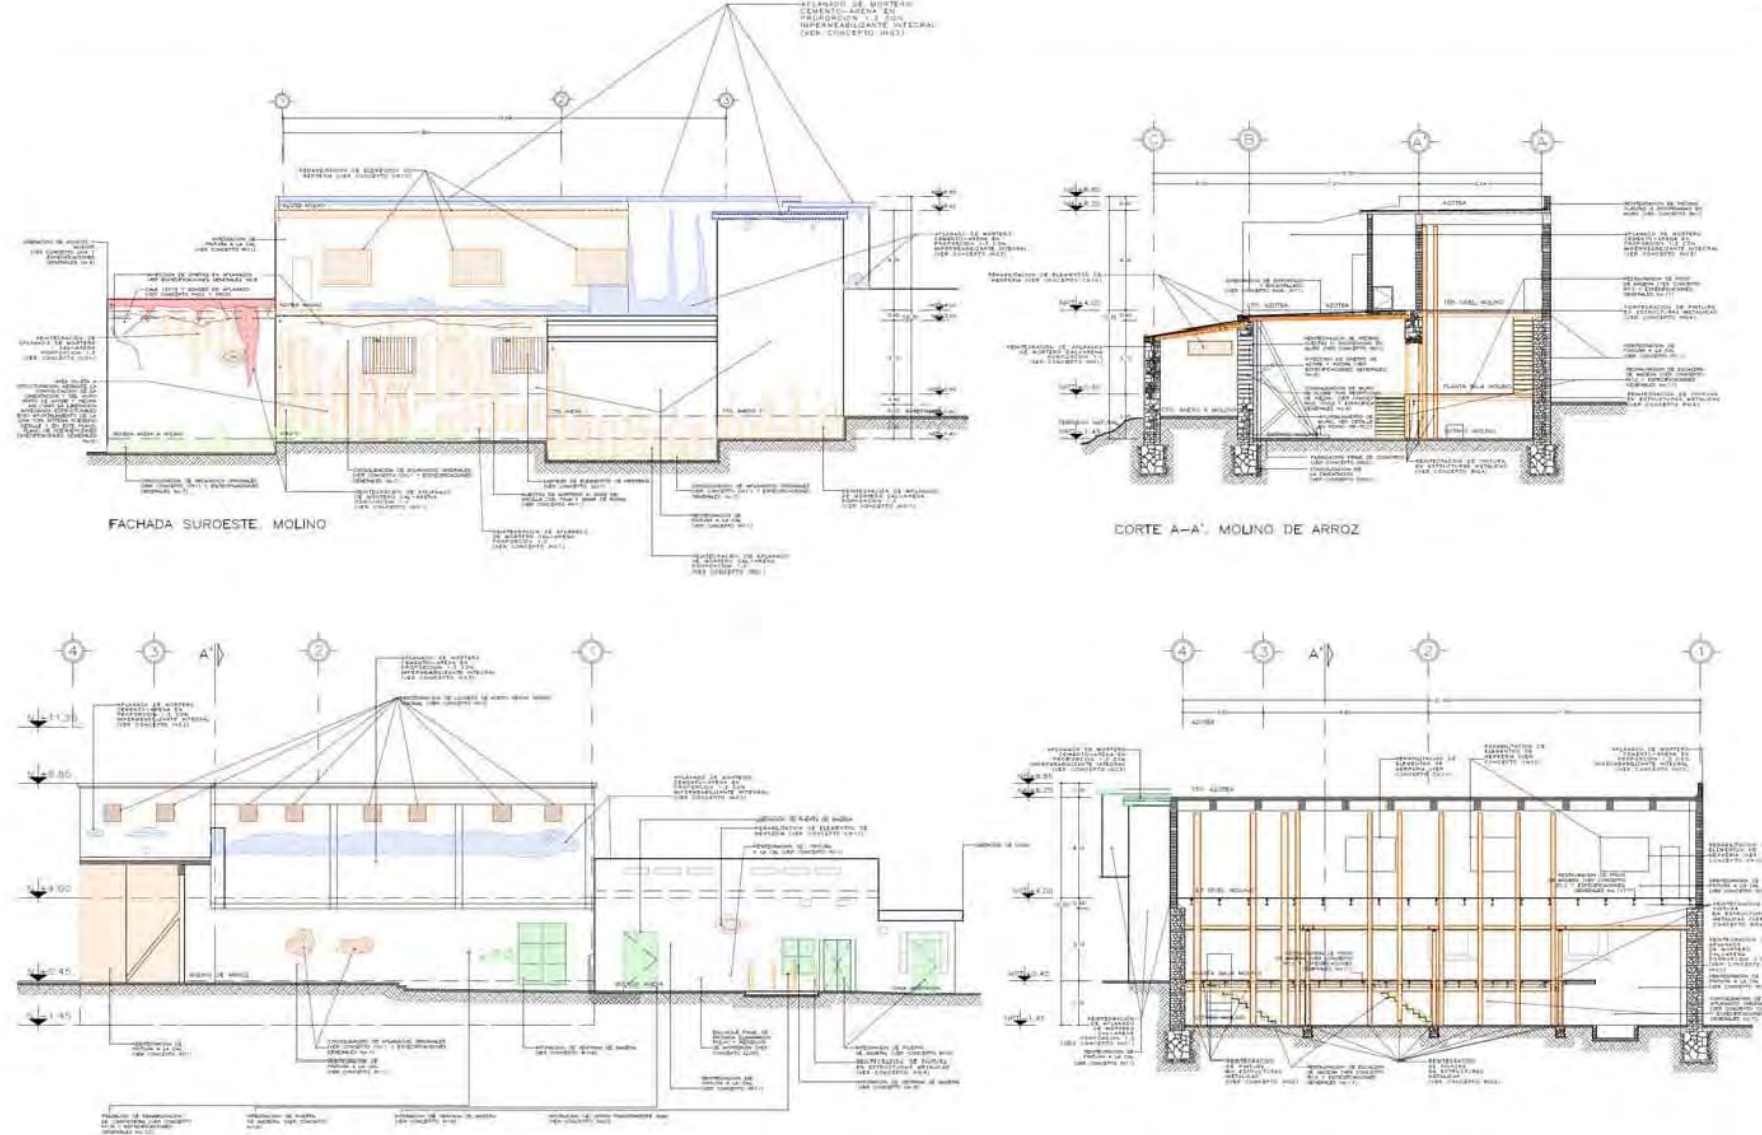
y 218.- Detalles de parte de los procedimientos para la restauración del muro de adobe del molino San José. Obras preliminares (216) y de consolidación (217) Realizó IPV. (Ver planos en Anexo)
